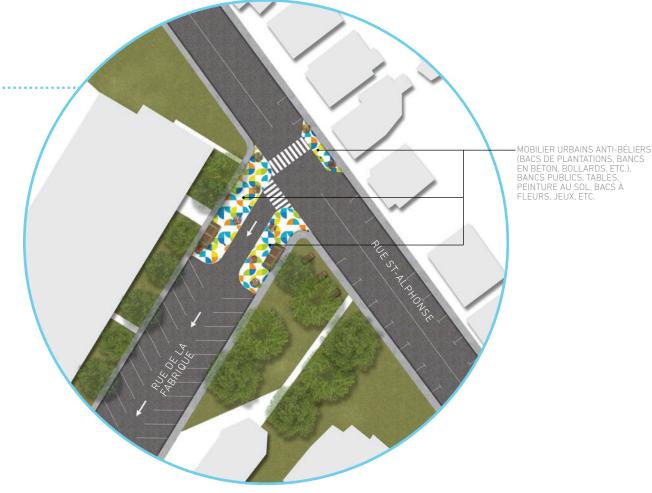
PLAN PROPOSÉE POUR L'INTERSECTION SAINT-ALPHONSE/DE LA FABRIQUE
